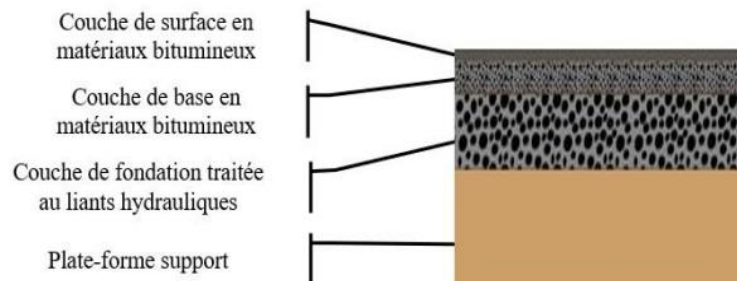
Structure d'une chaussée mixte (Nguyen, 2008).
